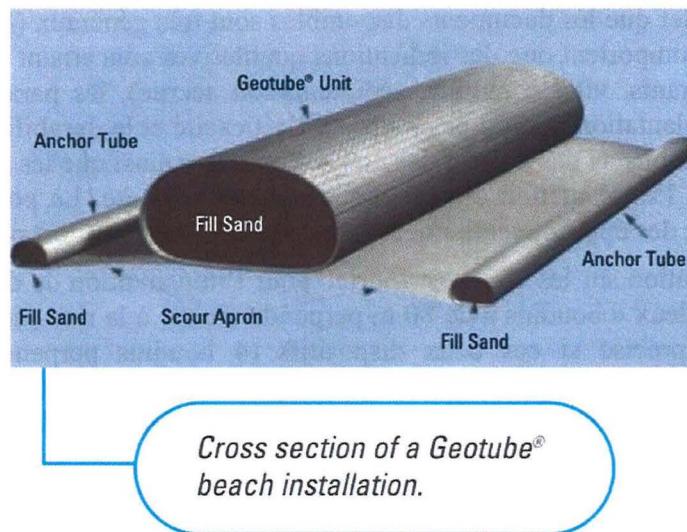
Variante de la technique Holmberg - Technique Geotube (Source : www.geotube.com)
